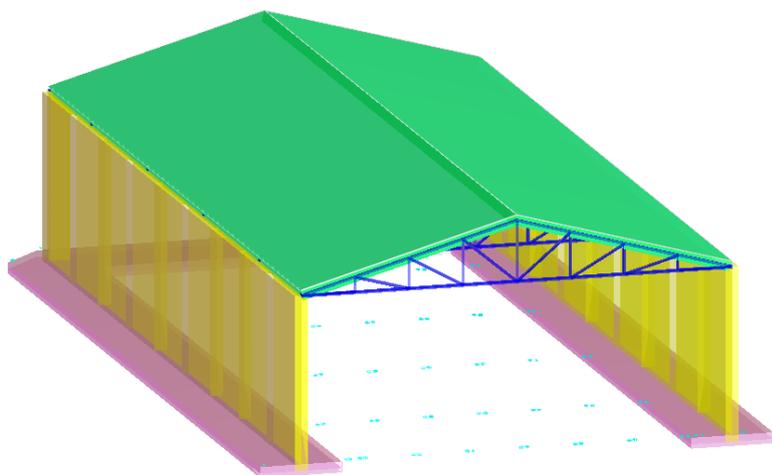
Struttura -Vista assonometrica della struttura nella sua interezza
